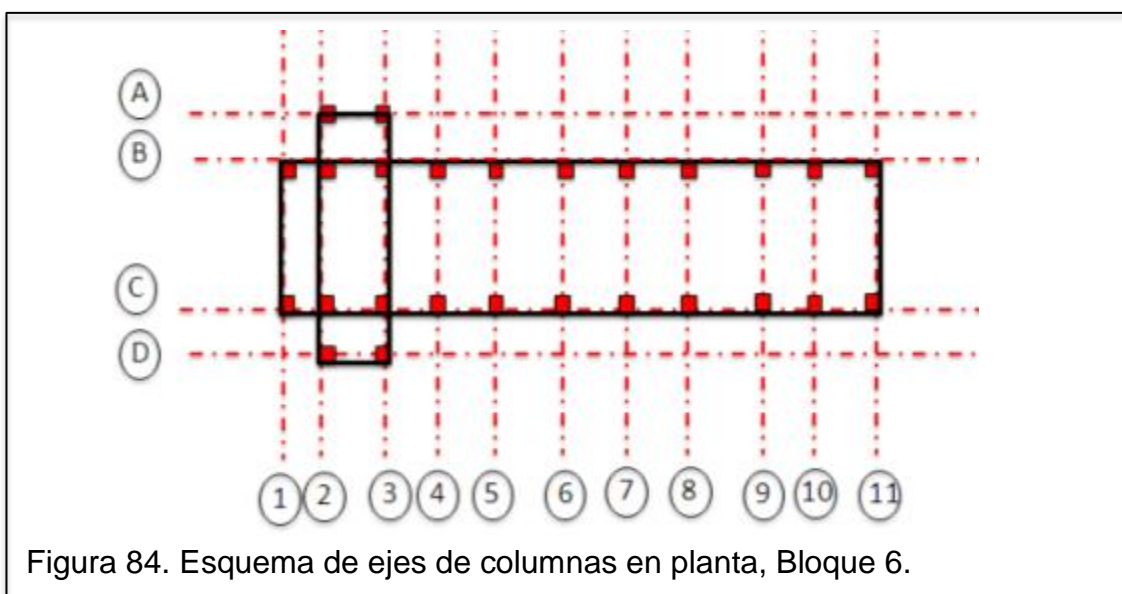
Esquema de ejes de columnas en planta, Bloque 6.
